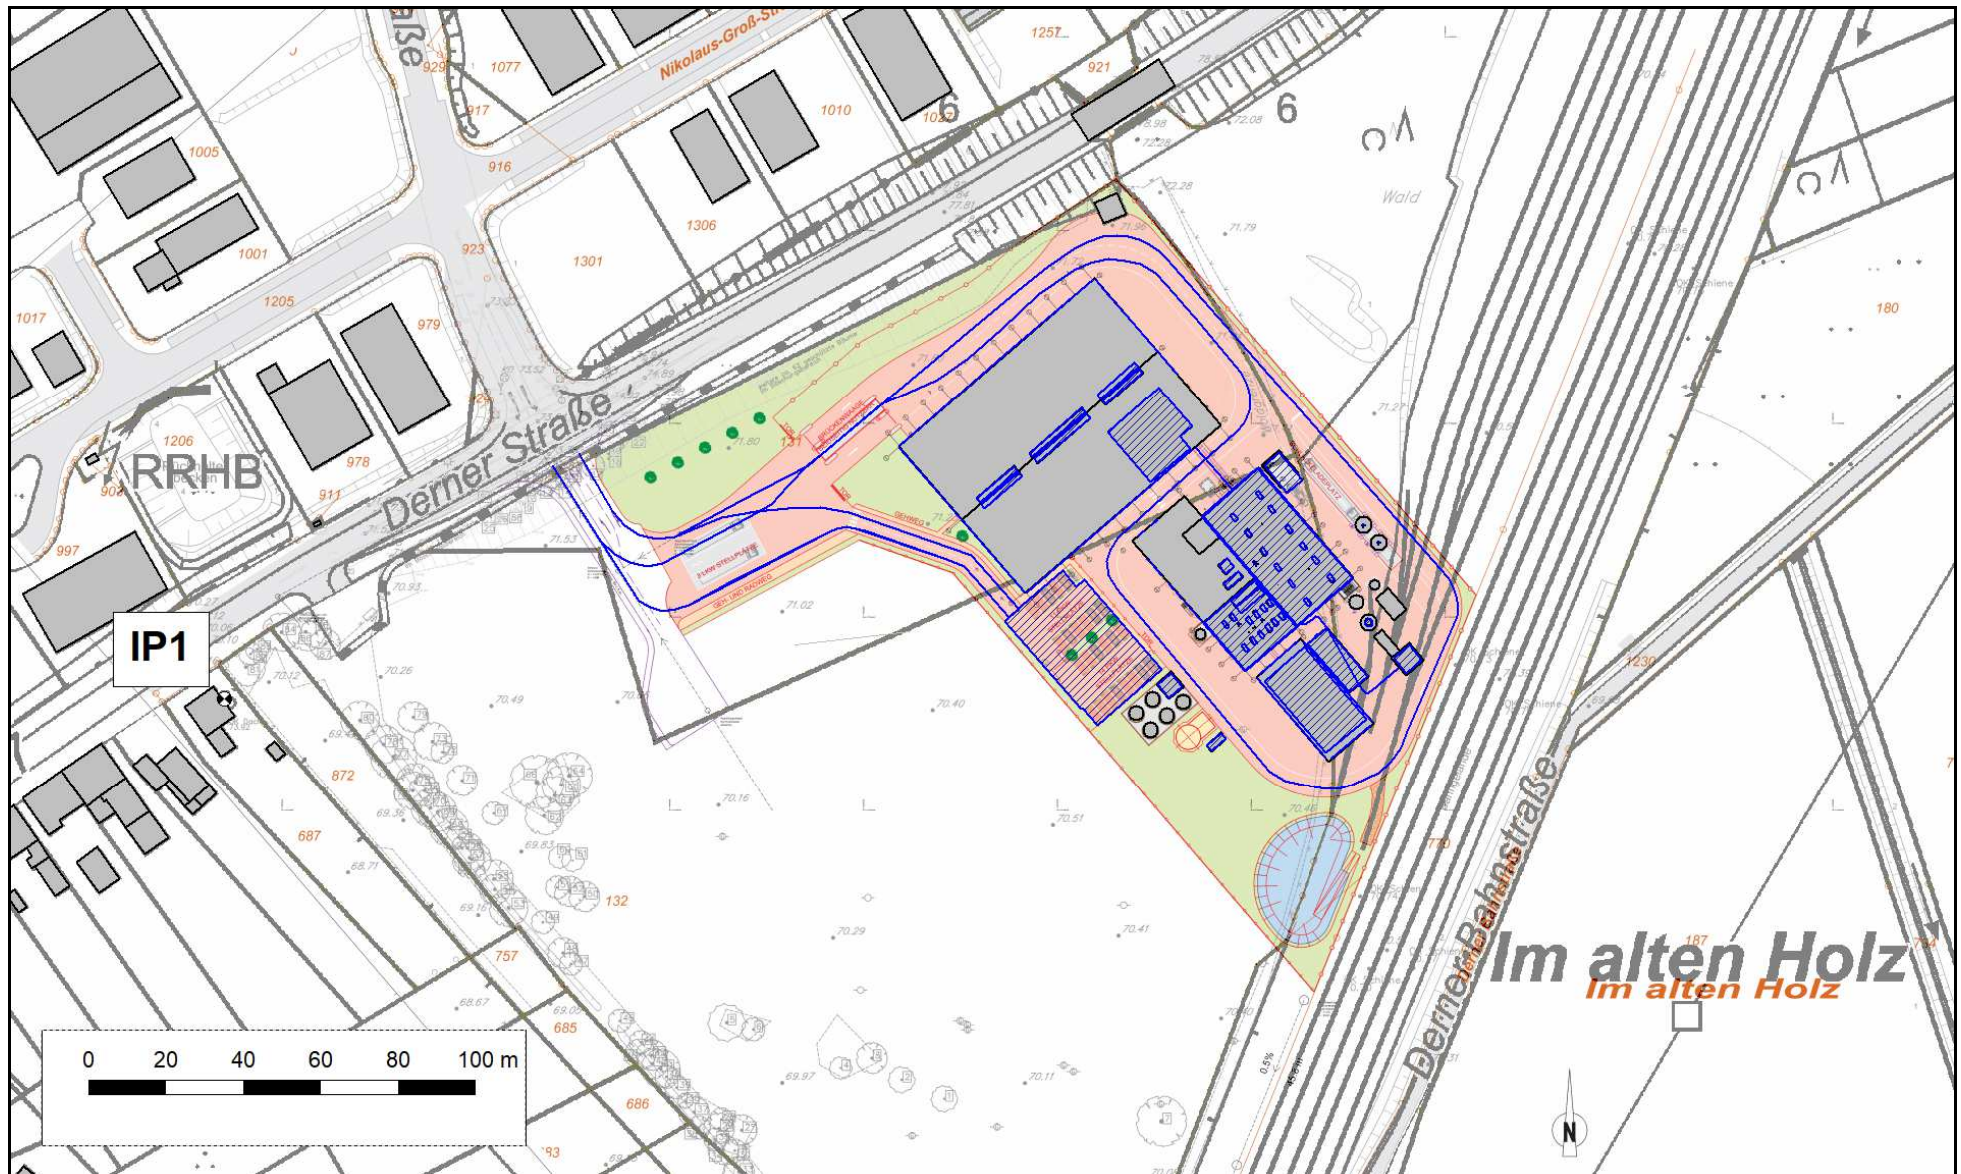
Übersichtsplan mit Lage der Immissionspunkte und der benachbarten Bebauungspläne
